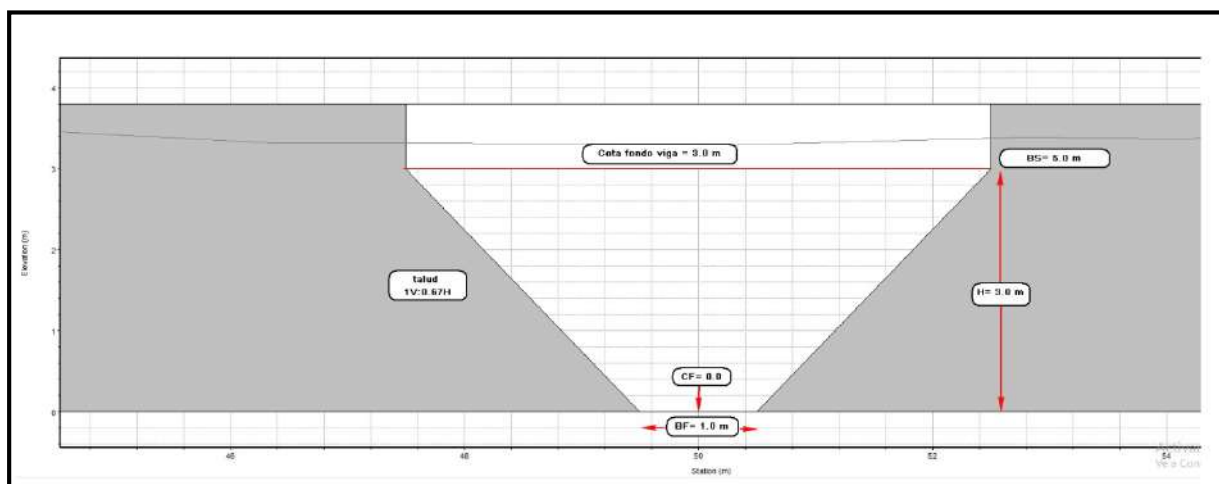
SP- 2D – Esquema modelado Perfil transversal progr. 510 - Proy. Requerido. Tipo 1
